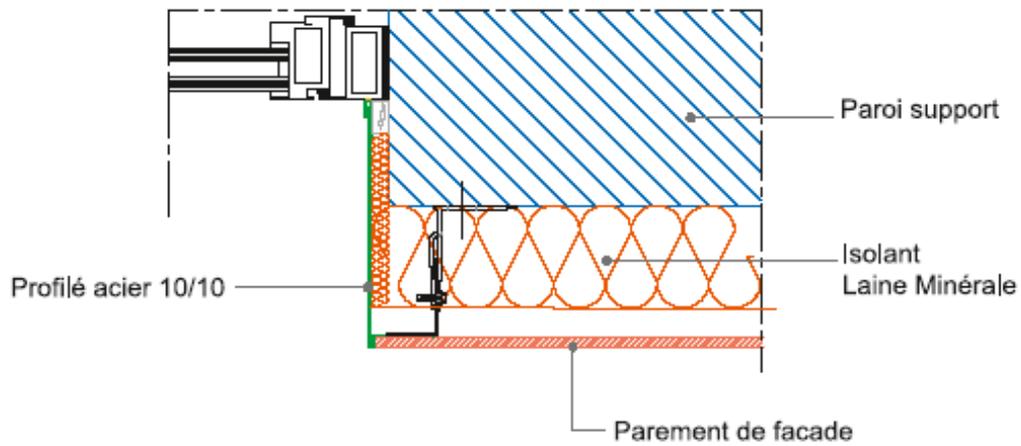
Coupe horizontale encadrement de la baie niveau tableau
